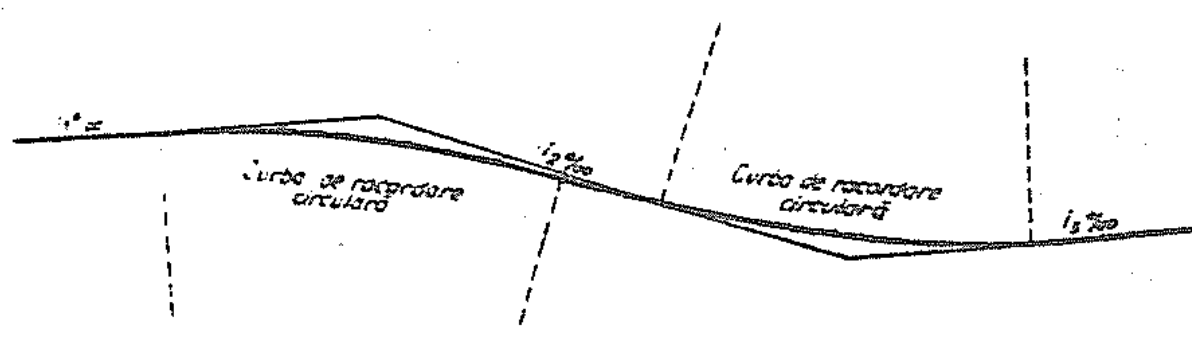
Racordarea elementelor de profil prin curbe circulare
